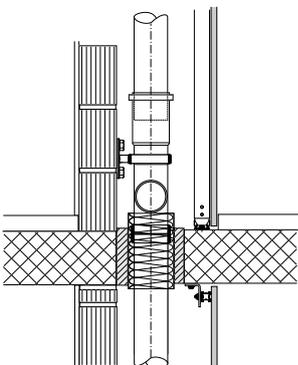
Schnitt A - A, Befestigungsdetail vom Duofix oder GIS Installationssystem neben Deckendurchbruch
